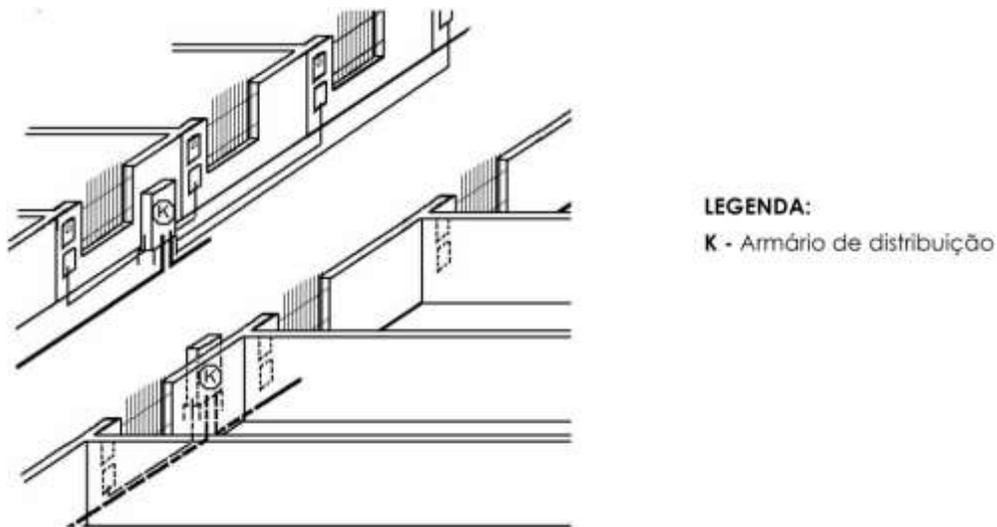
Ligações a partir de rede subterrânea, construções dotadas de muro (Fonte: [comum.rcaap.pt](http://comum.rcaap.pt))
